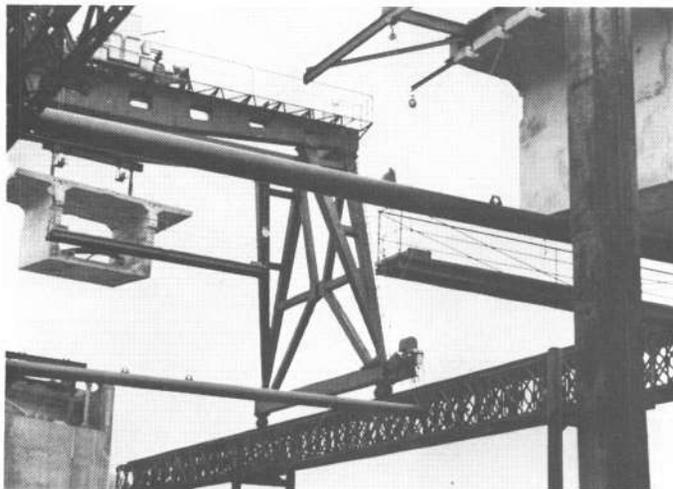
Clavage d'une travée à voussoirs préfabriqués.
